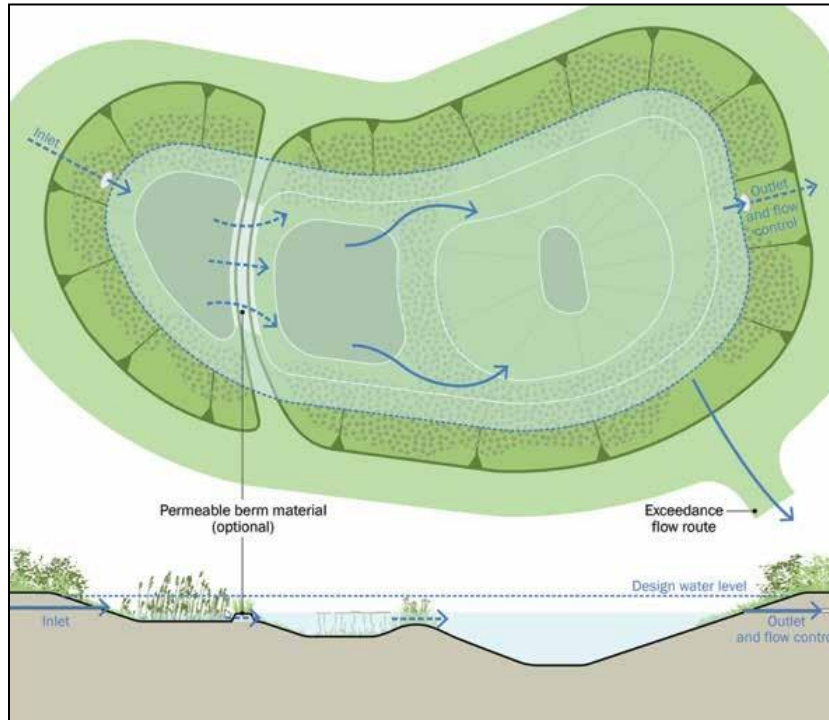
Vista del plano y perfil de los detalles de Laguna de infiltración.
